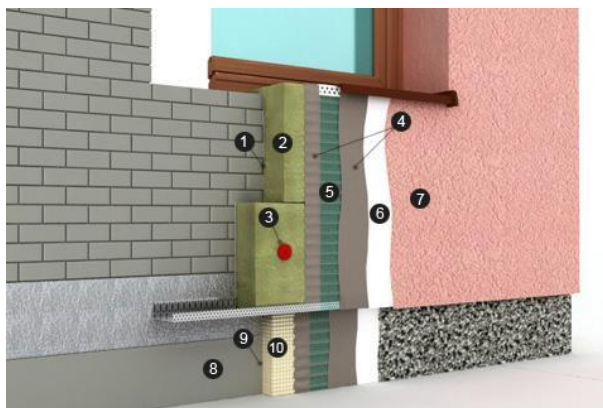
Система утепления фасадов на минеральной вате Стена: 1 – клей; 2 – плиты минеральной ваты; 3 – дюбель; 4 – базовый штукатурный слой; 5 – стеклосетка; 6 – грунтовка под отделку; 7 – декоративный штукатурный слой; Цоколь: 8 – гидроизоляционный слой; 9 – клей; 10 – экструдированный пенополистирол.
